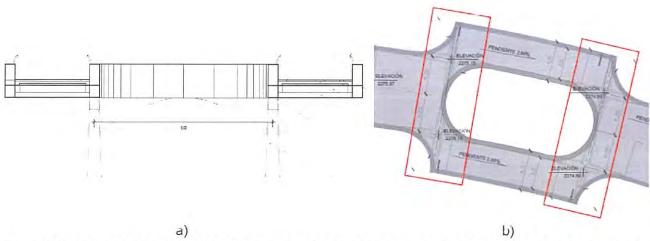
Columna de propuesta definitiva: a) vista en corte de cruceta, b) vista en planta de crucetas.
